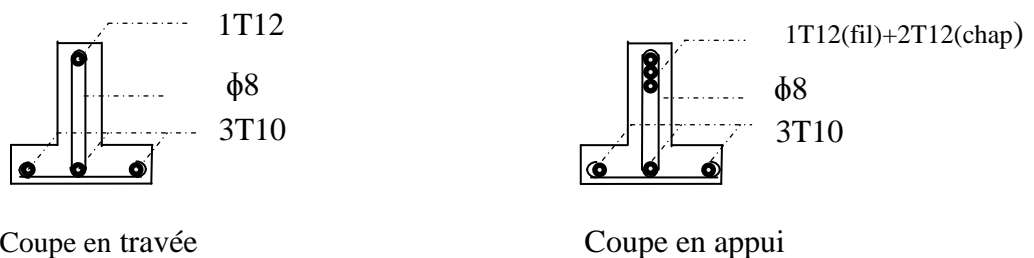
Schémas ferrailage des poutrelles Plancher étage courant (Poutrelles intermédiaire).
